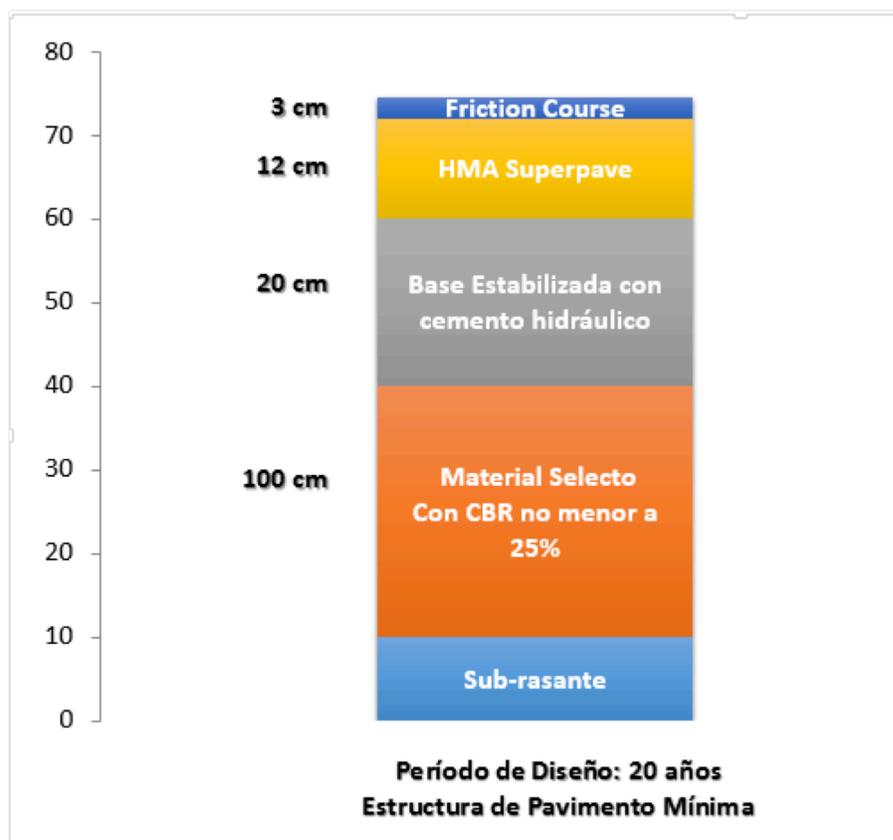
sección de estructura de pavimento propuesta
